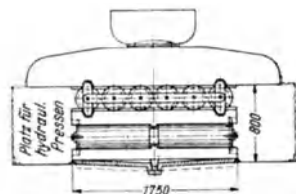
Allseitig bewegliches Lager der Jannowitzbrücke in Berlin. Nach LA BAUME: Bautechnik 11 (1933) S. 460.
